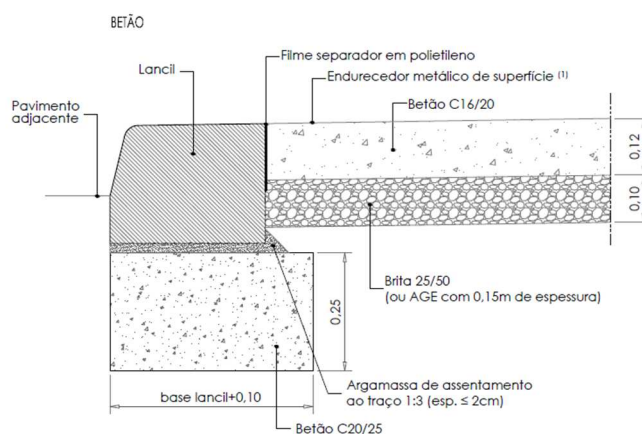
Exemplo de estrutura de pavimento-tipo da CMP (revestimento em betão) (Câmara Municipal do Porto, 2013b).
